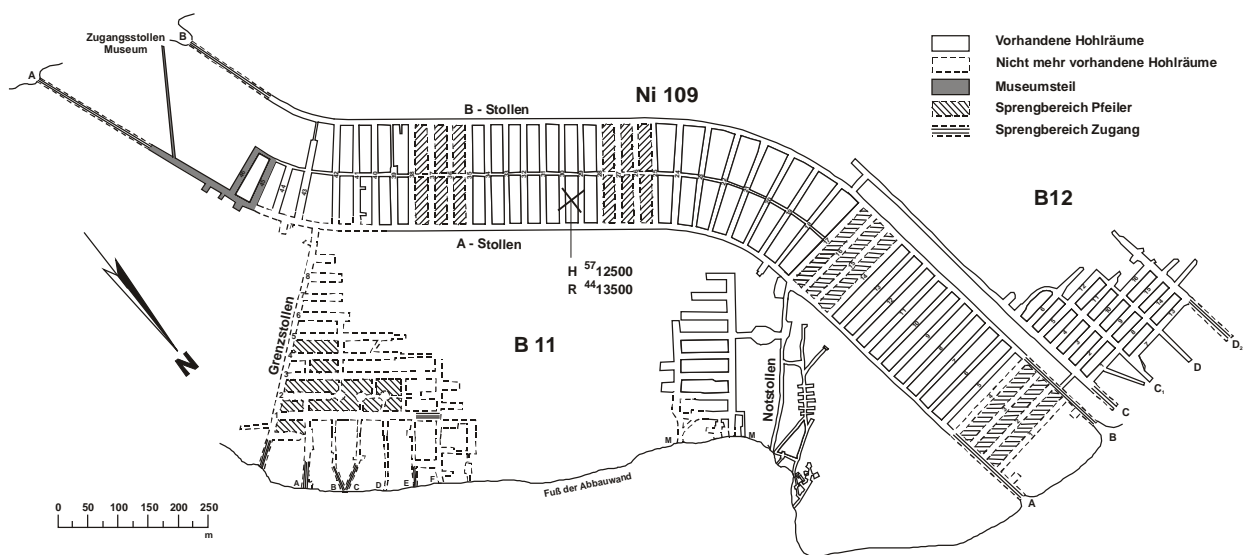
Lageplan der unterirdischen Anlagen im Kohnstein bei Nordhausen
